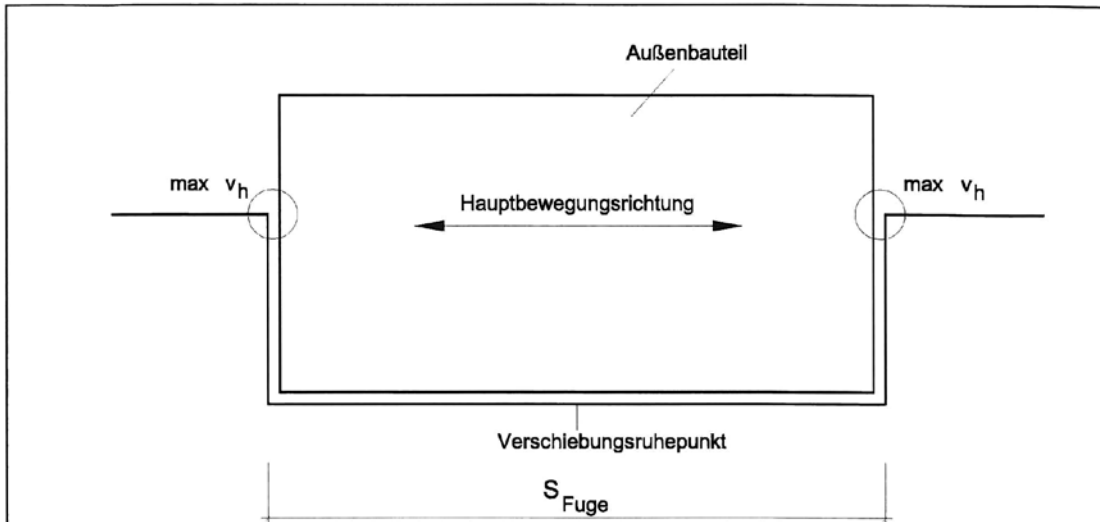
Einbausituation mit Lagerung an gegenüberliegenden Rändern
